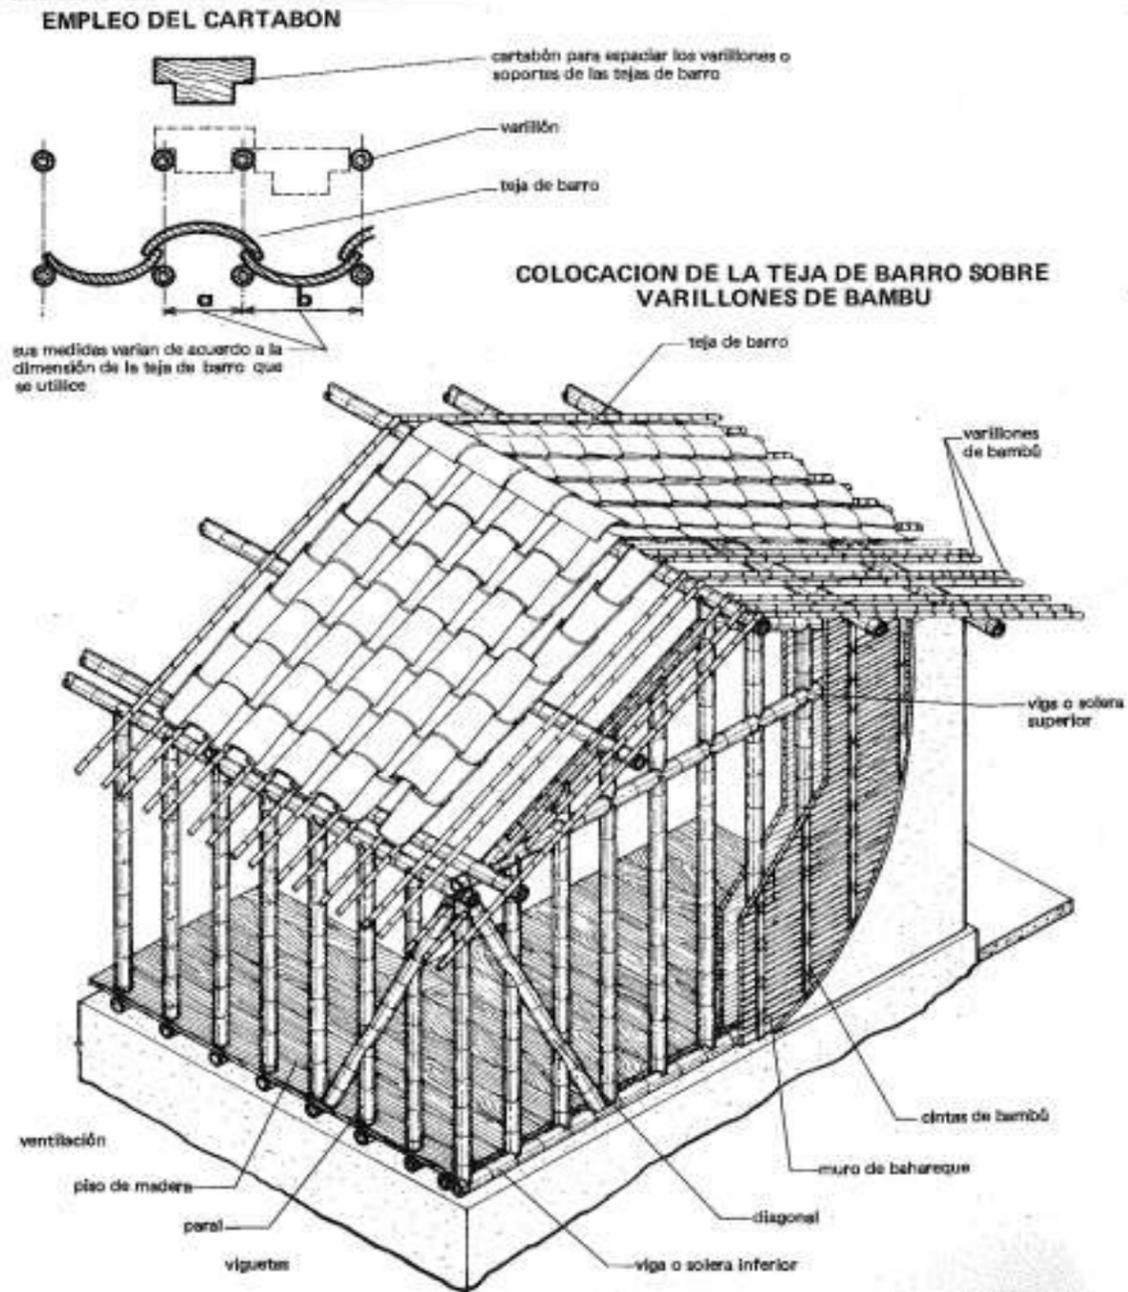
Detalle de estructura de techo. Fuente: Manual del bambú.
